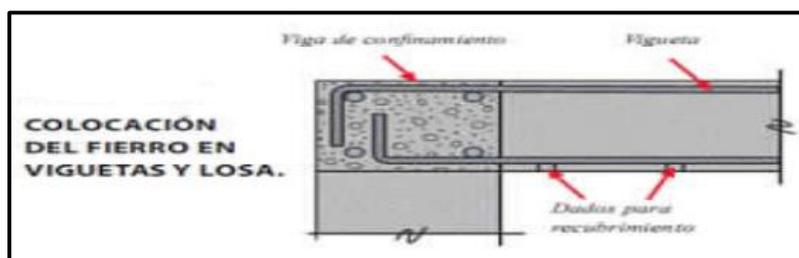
Detalle de colocación de fierros en viguetas y losa.
